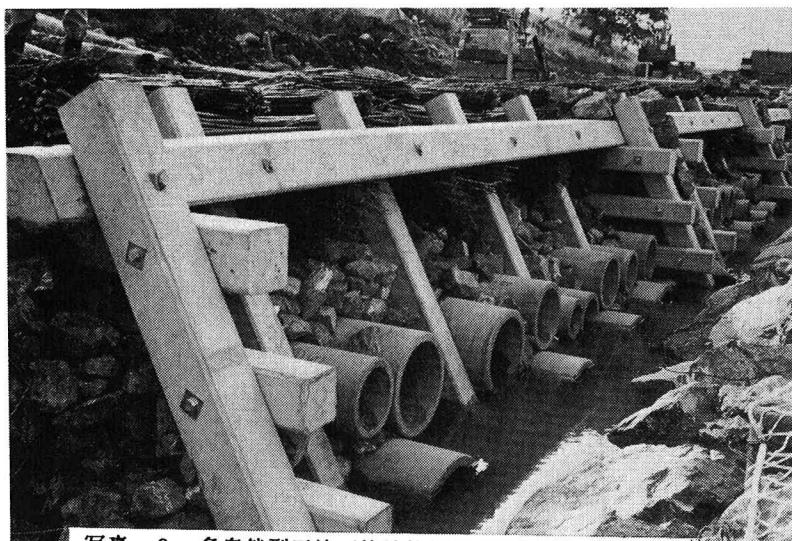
多自然型工法（片法枠埋幹工法）現場施工状況
